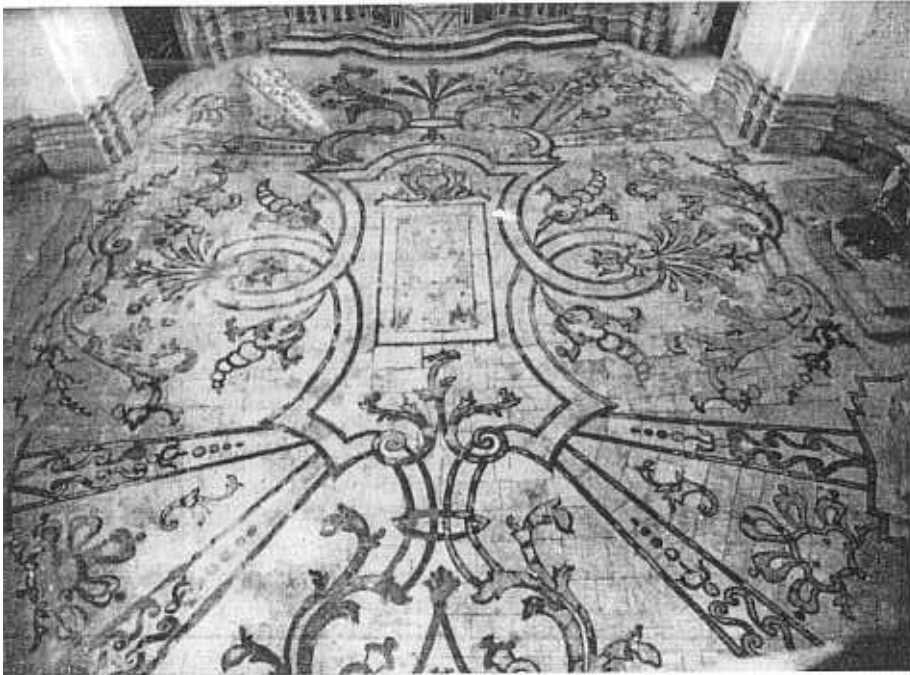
Siracusa. Chiesa di San Filippo Neri. Pavimento prima del restauro.
